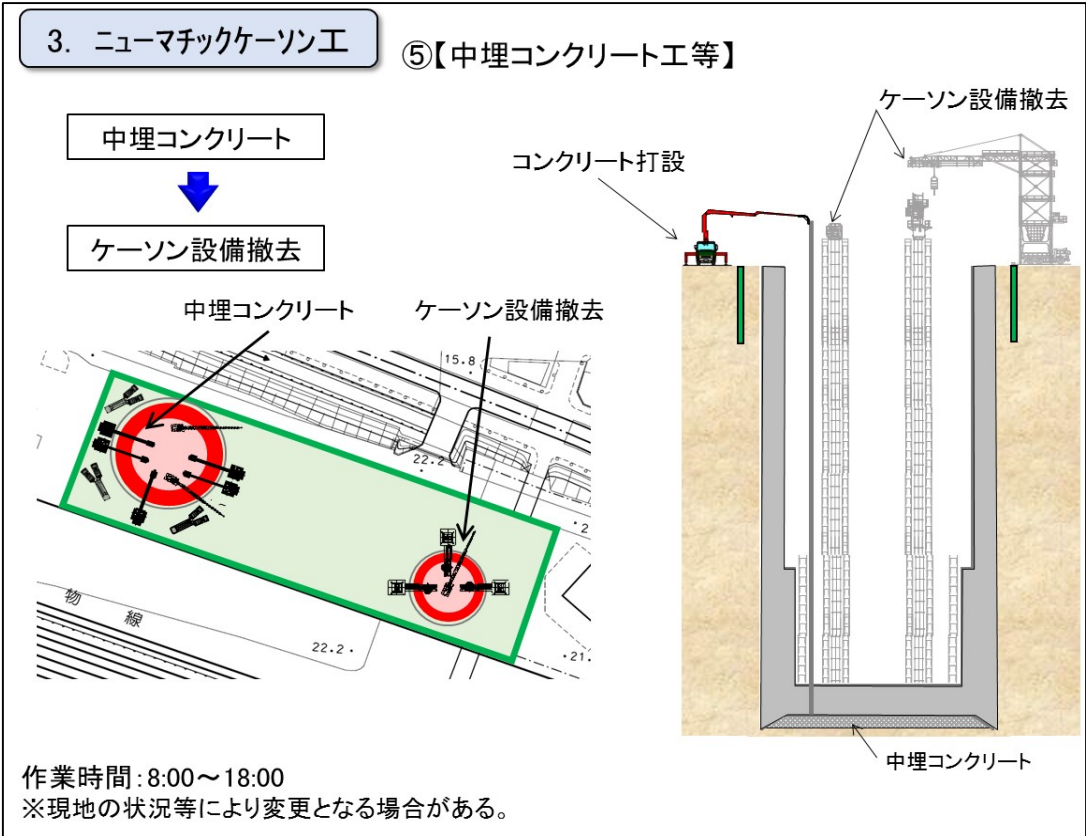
(8) ニューマチックケーソン工の施工手順⑤
